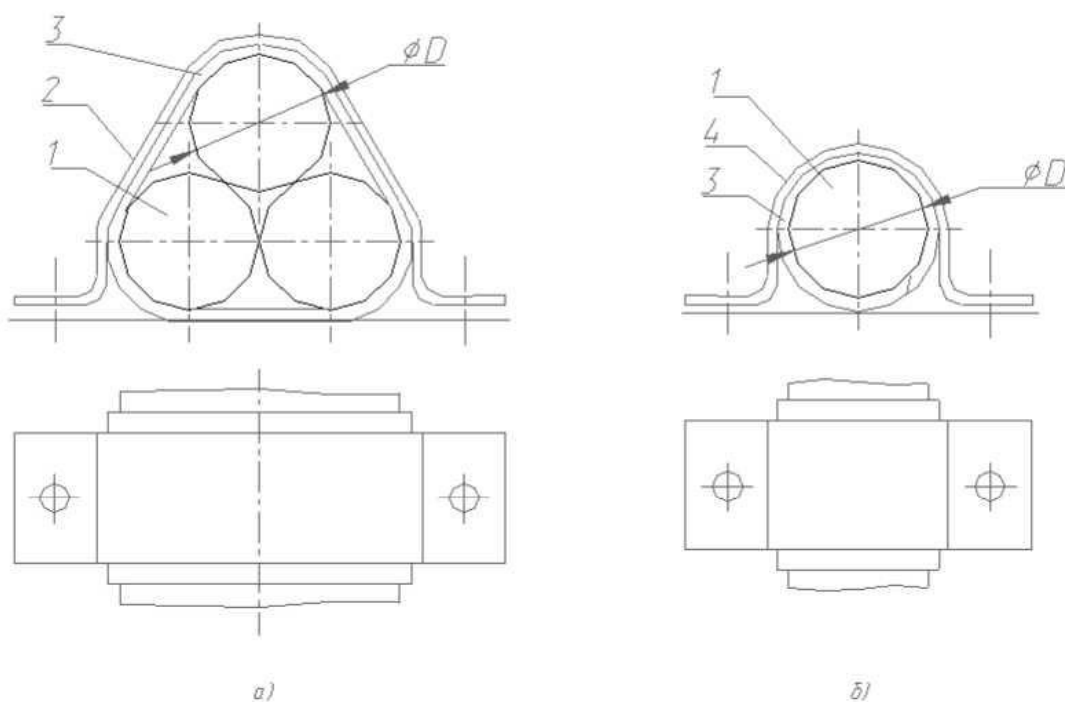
Варианты крепления кабелей на металлоконструкциях.
